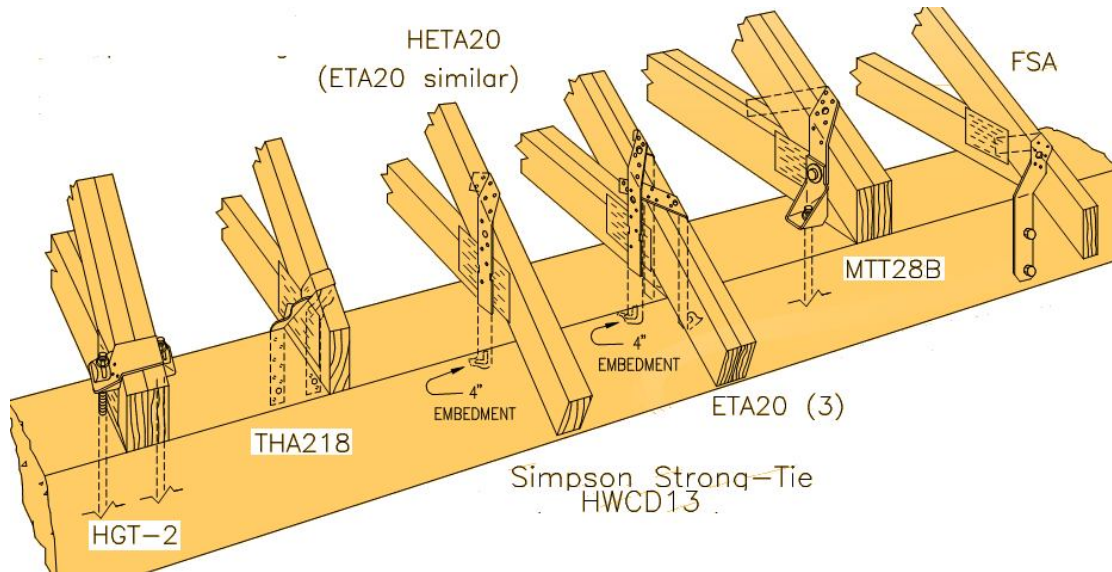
Conectores para Armaduras Coladas y Fijadas al Concreto
